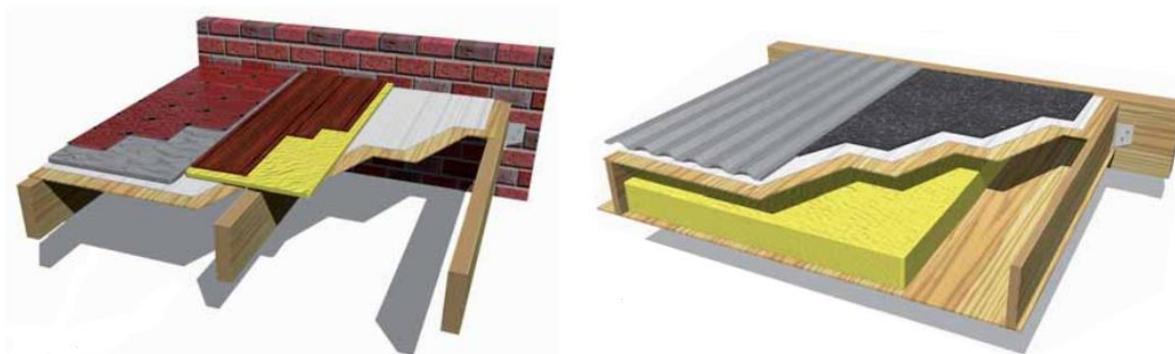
A la izquierda, sistema para el forjado inferior, con panel de acabado transitable. A la derecha, el sistema a utilizar para la cubierta, con cámara y aislante intermedio. Año 2016. www.tallfusta.com.
